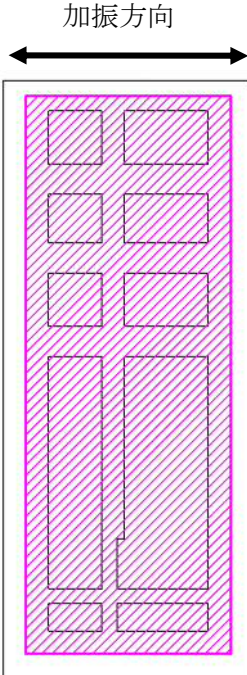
(2) 立坑の平面配置図 (拡大図)
